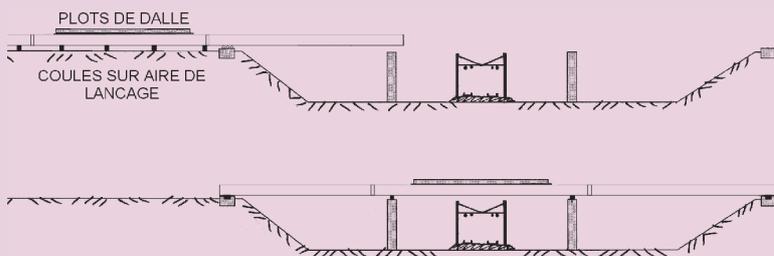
Lançage avec plots de dalle coulés sur l'aire d'assemblage
